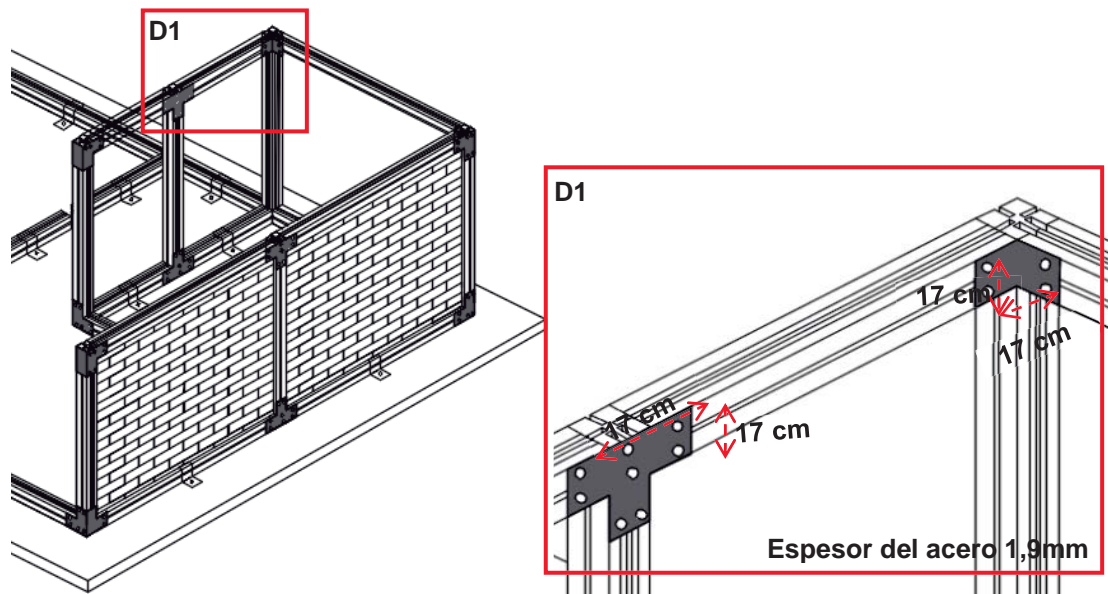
Anclaje de viga a viga - AutoCAD, 2018
